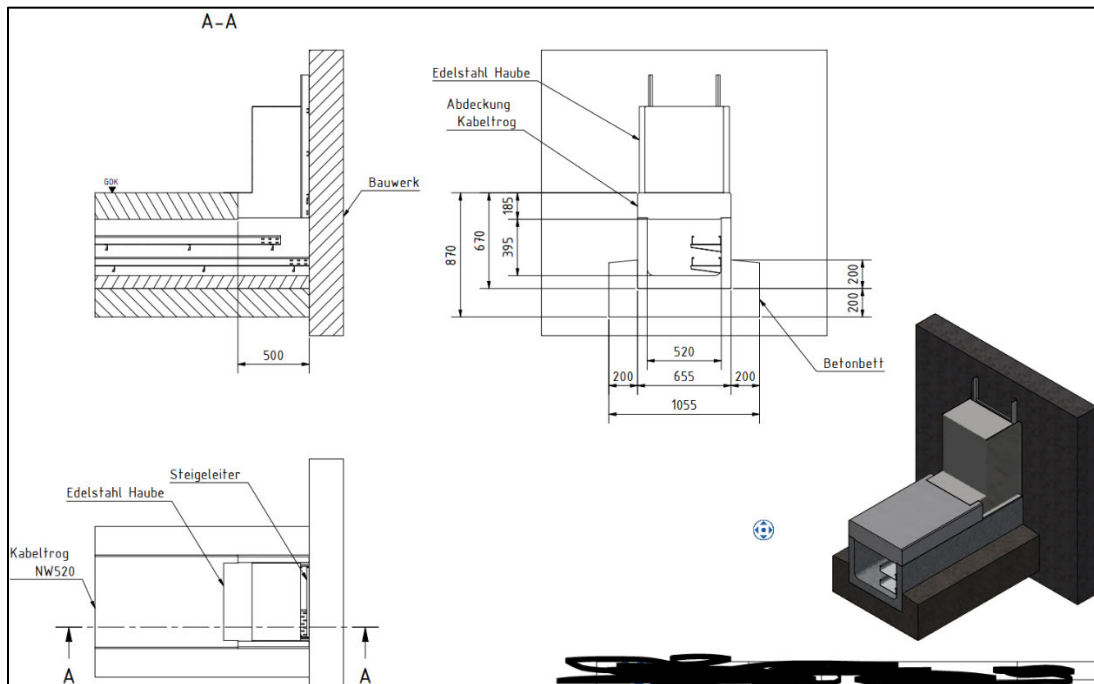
Ausführung Stumpfstoß an Gebäude mit Betontröge
